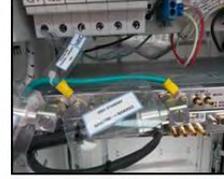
FOTO MARQUILLAS A TIERRA DE LA COLUMNA
